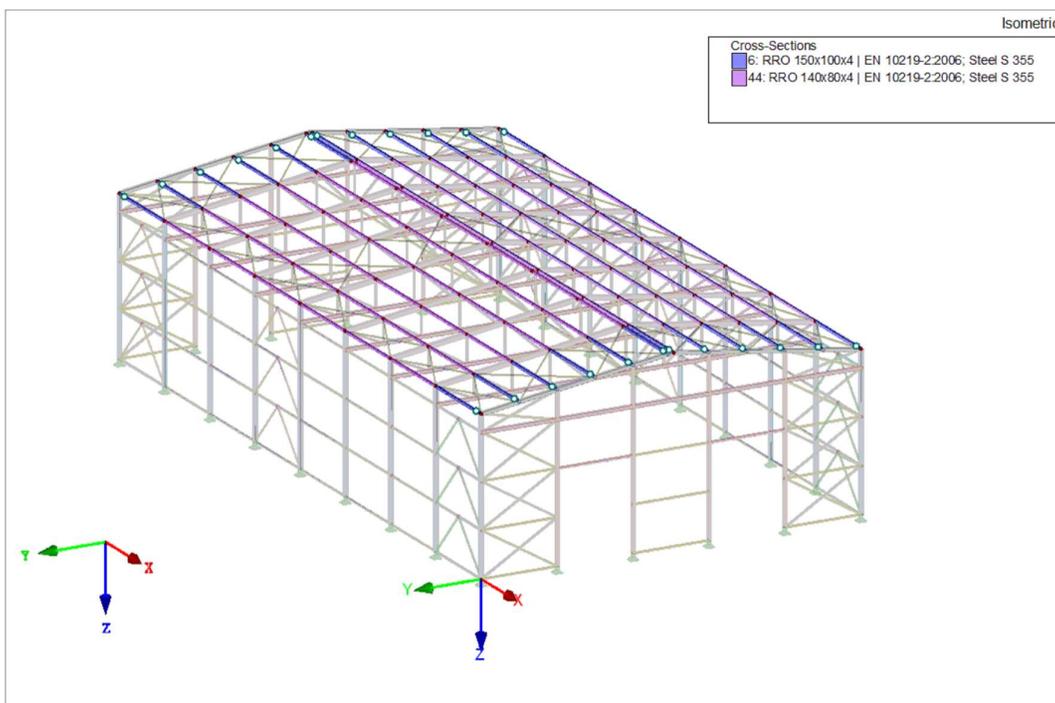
Plan pozicije gornjeg i donjeg pojasa rešetke
